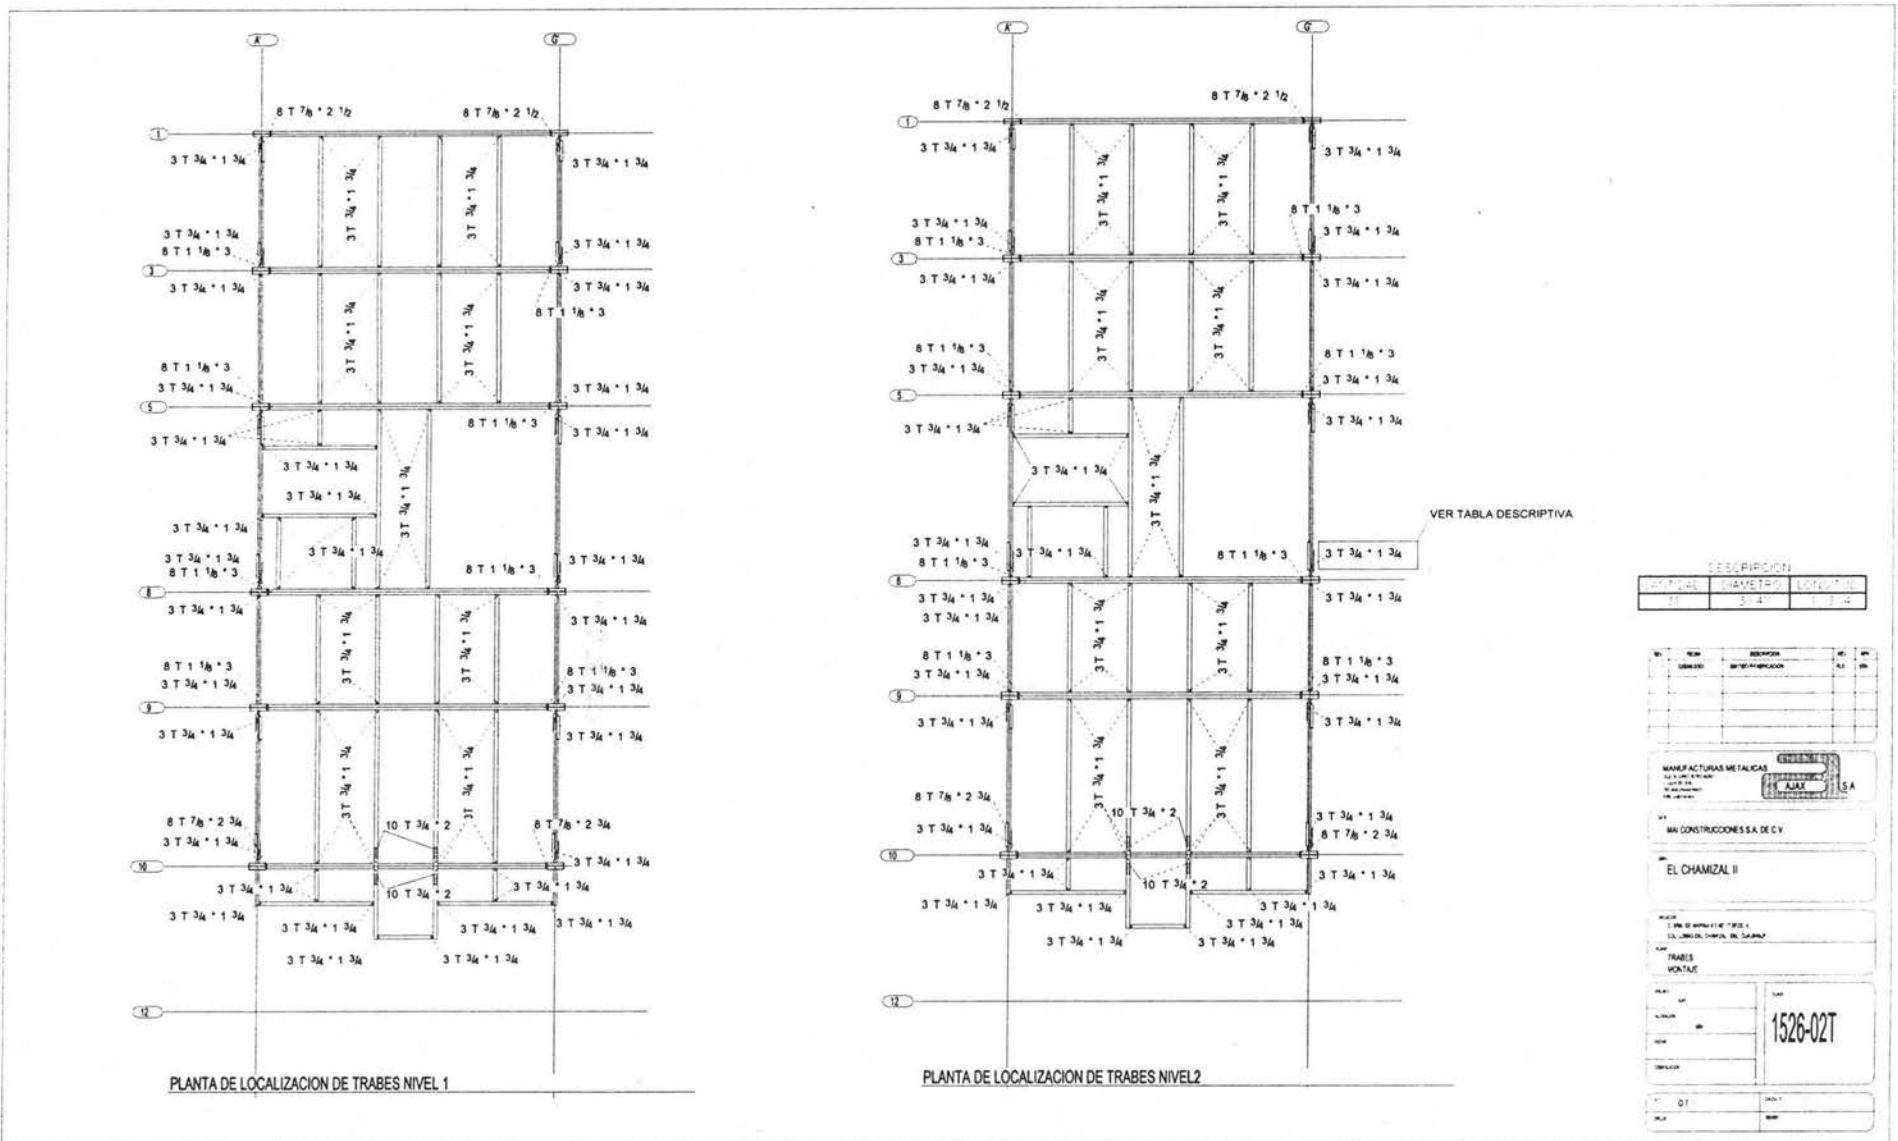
Plano de tornillería (trabes nivel 1 y 2).
